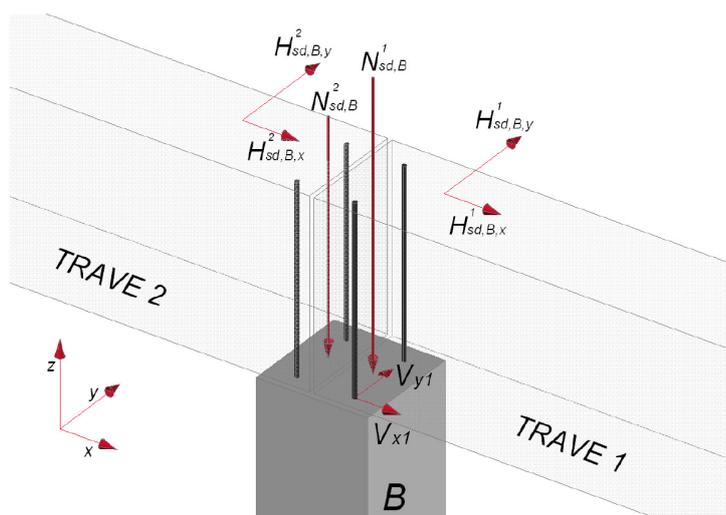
Collegamento efficace trave – pilastro (dalla pubblicazione "Linee Guida per la progettazione sismica di strutture prefabbricate"- ASSOBETON Sezione Strutture Prefabbricate – 2011)
